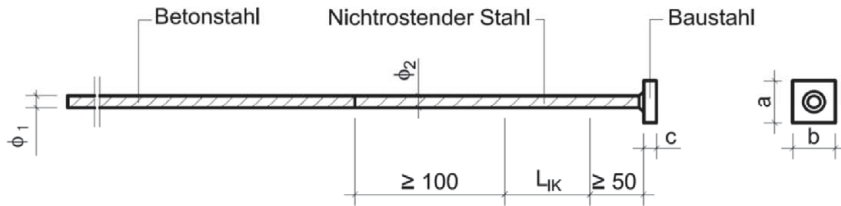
Druckelement aus Stahl mit angeschweißter Druckplatte und angeschweißtem Betonstahl
